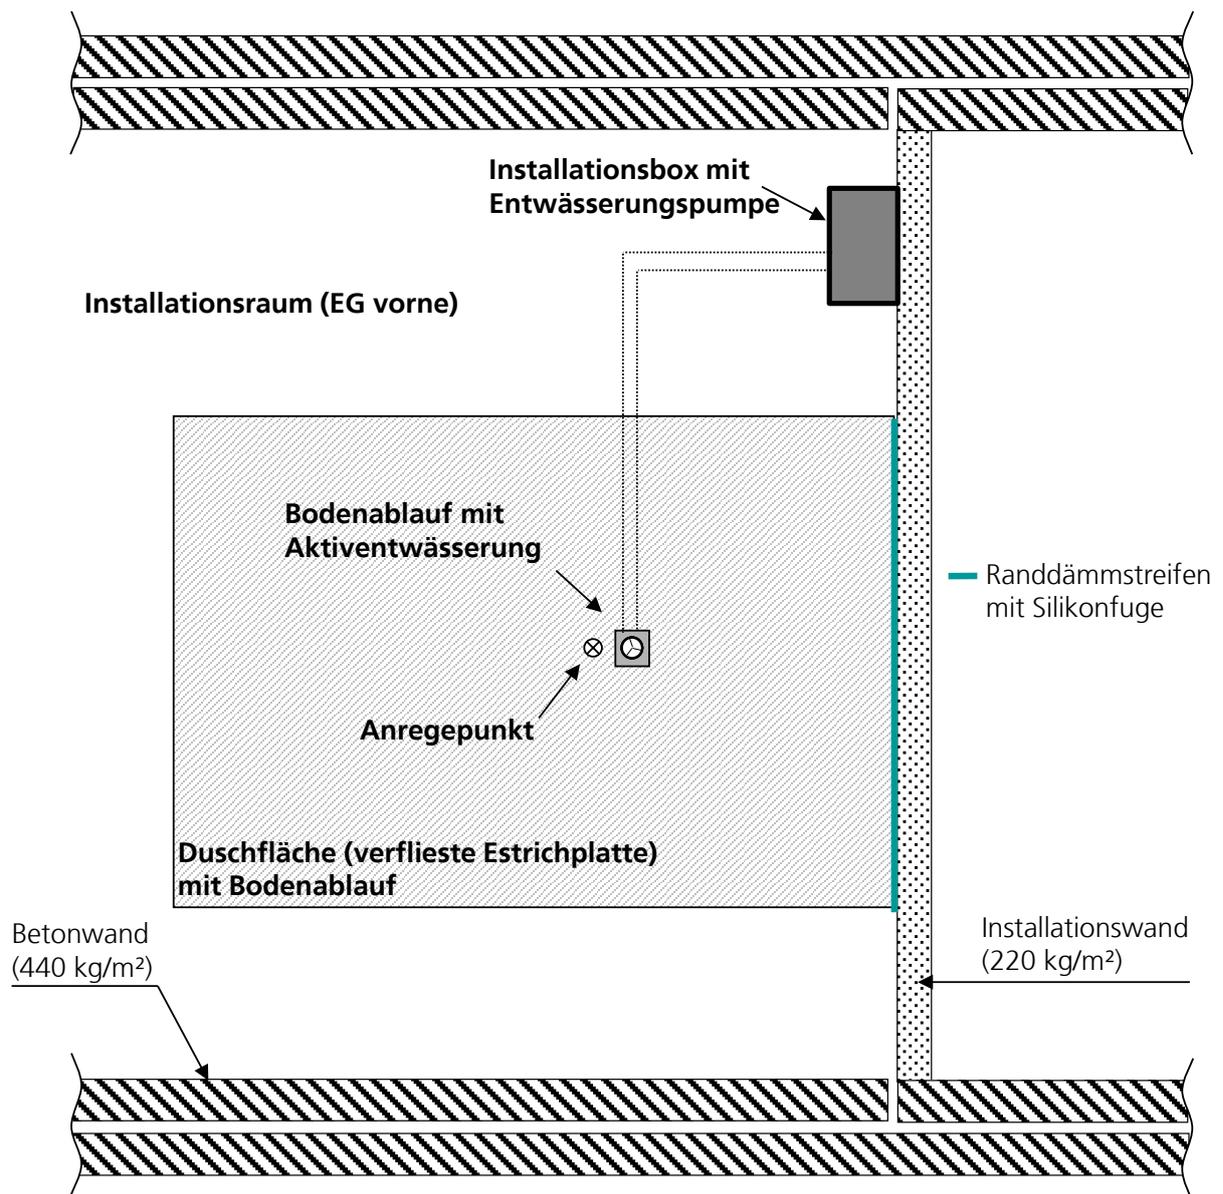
Lage der Duschfläche mit Bodenablauf im Installationsraum (EG vorne).
